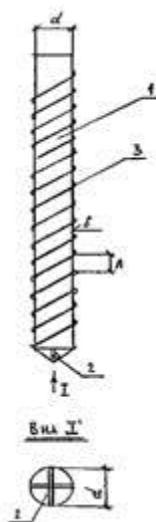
Общий вид бурозавинчивающейся сваи
